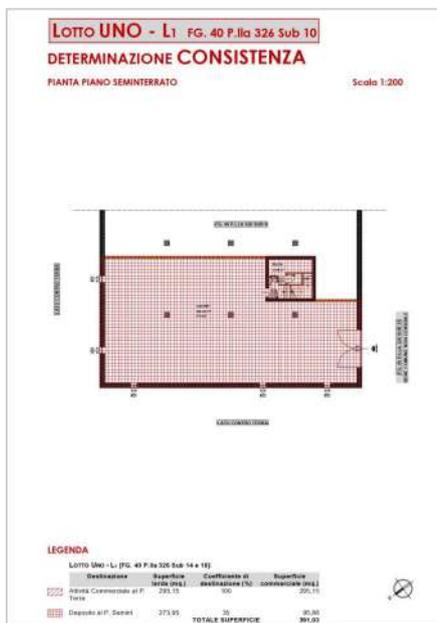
Determinazione consistenza Lotto L1 (ALL. 11).
